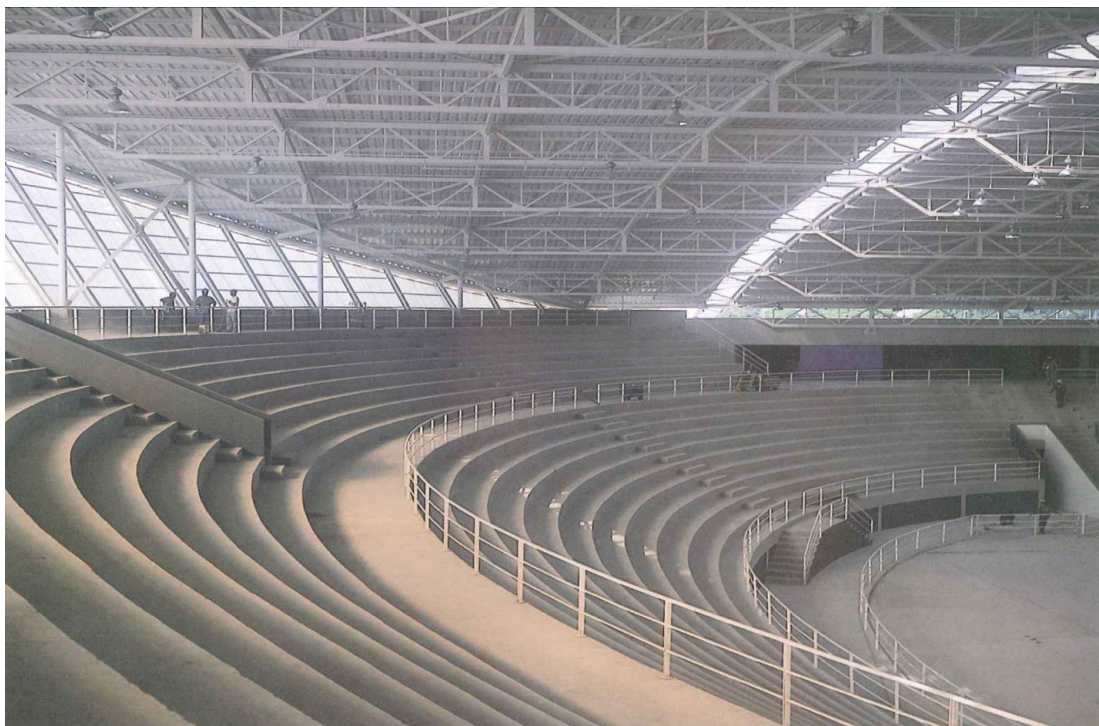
Vista interna das arquibancadas ainda em obras.
